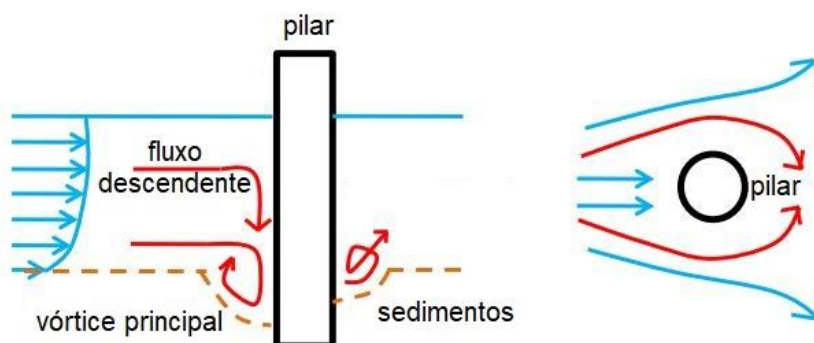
Infraescavação em pilares (Adaptada de Wang et al., 2017).
